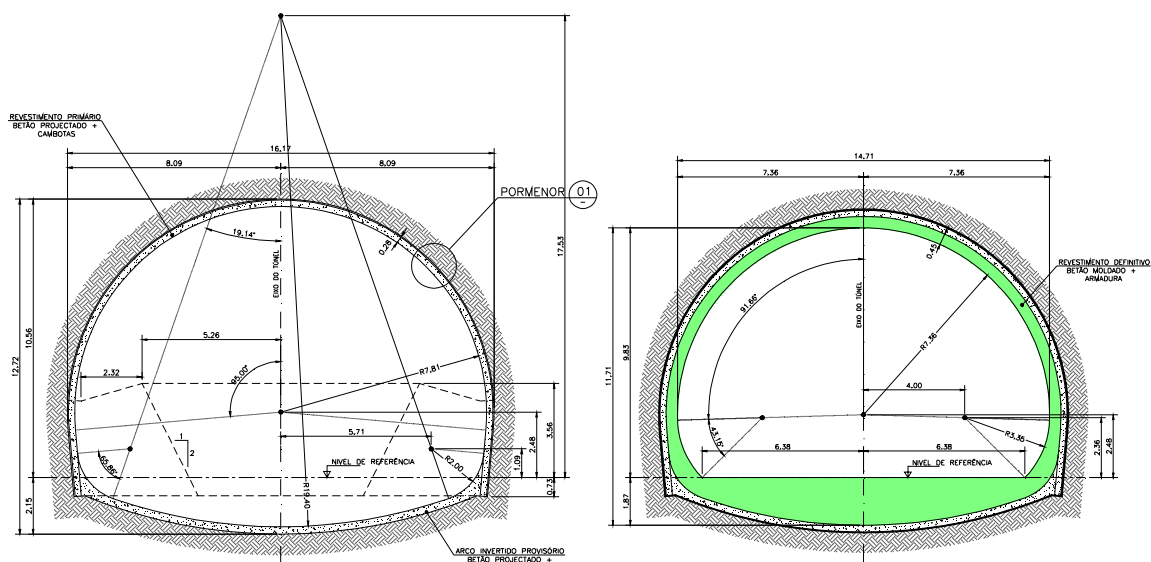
Túnel das Salas de Ventilação – Secção Transversal
